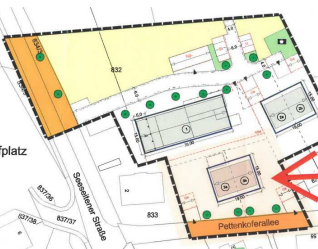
Ur- Plan des Bebauungsplans „Westlich Pfarrer Behr Weg“, Stand 19.08.2005
